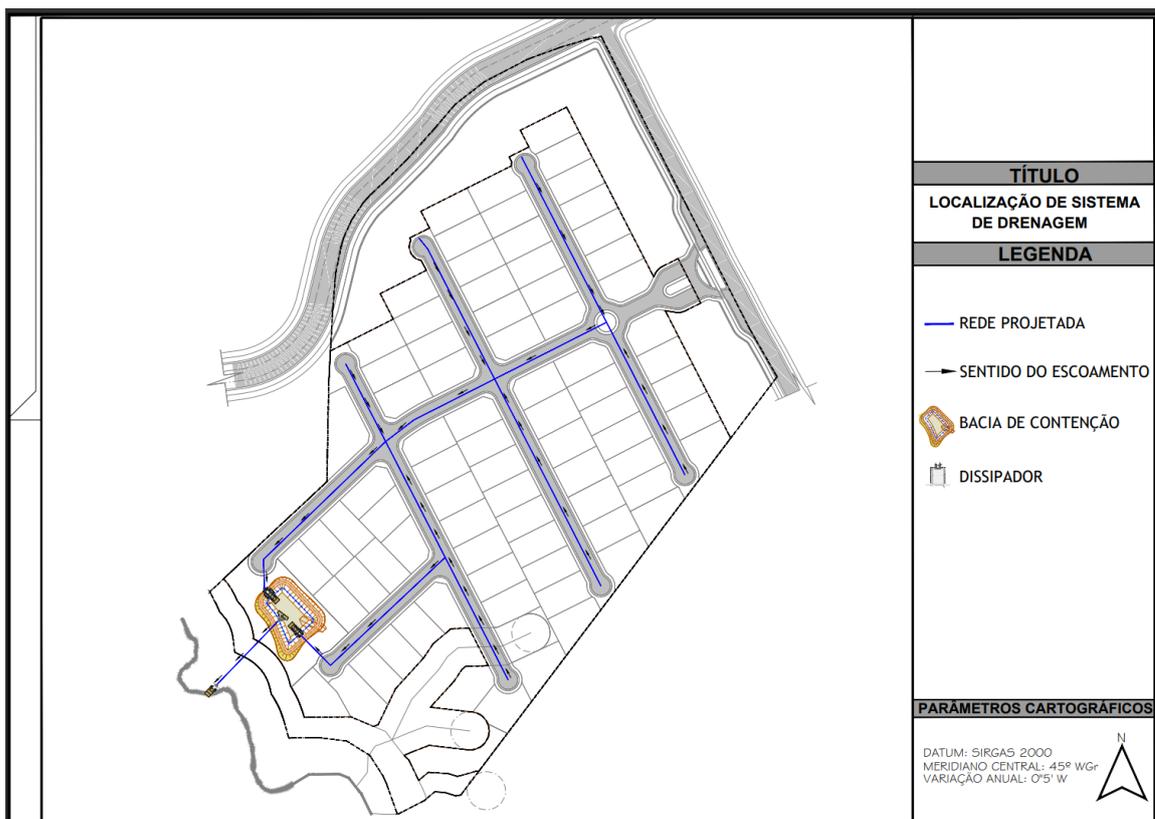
Croqui do Sistema de Amortecimento de Vazão
